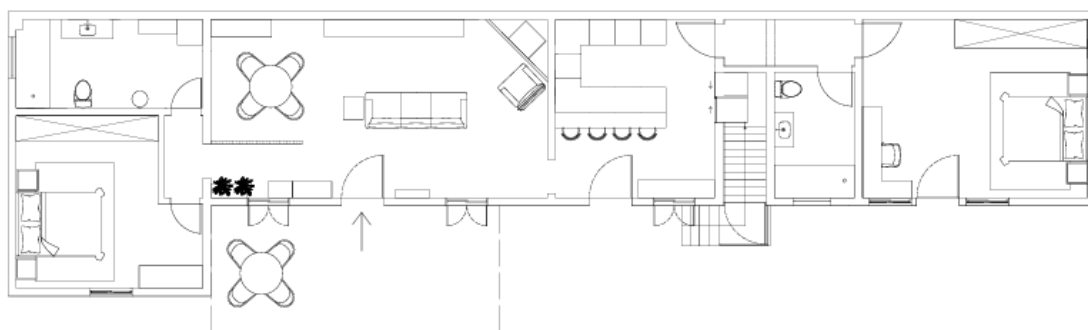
Planta da primeira proposta preliminar Fonte: Autor
